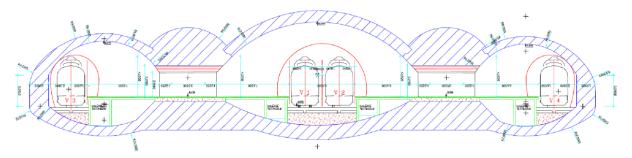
Coupe transversale de la gare Haussmann-Saint-Lazare au droit des quais (5)
